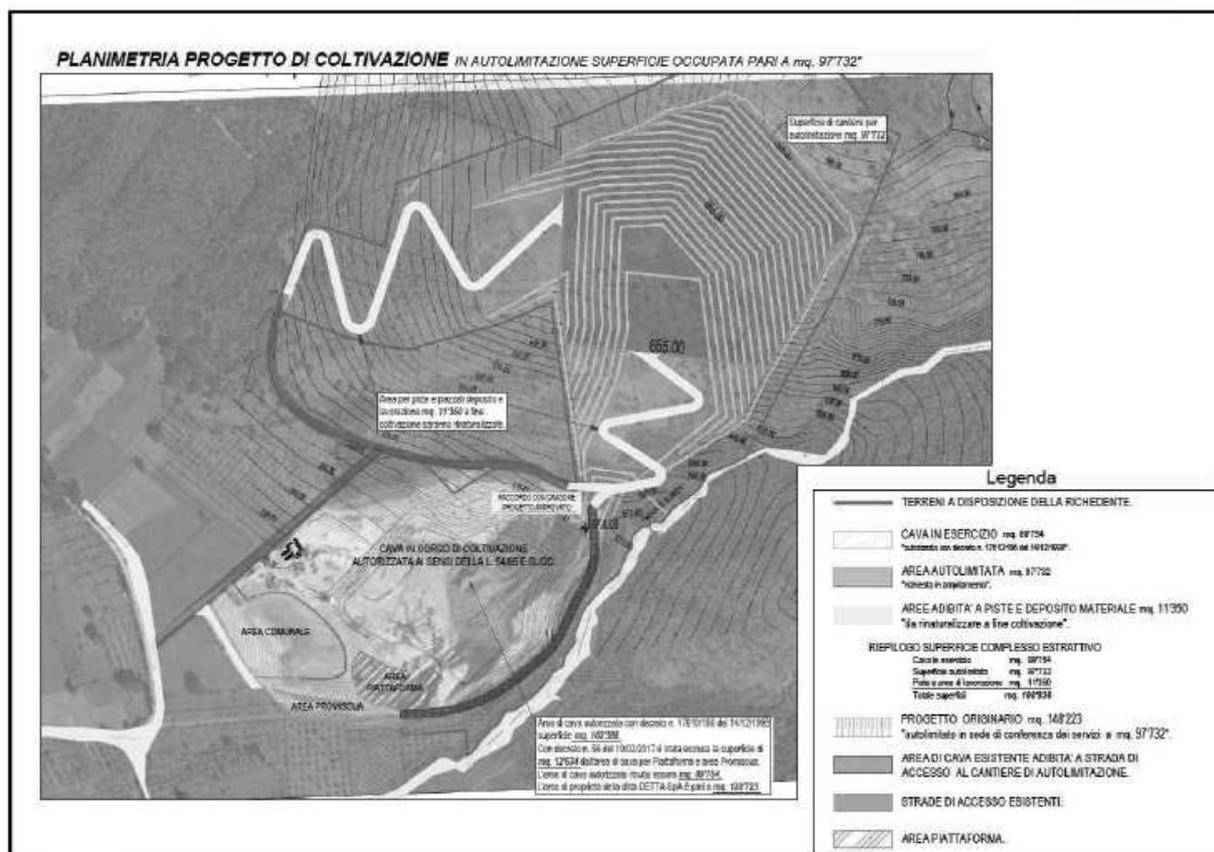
Stralcio planimetrico con individuazione delle aree del complesso estrattivo (fonte: documentazione di progetto)
